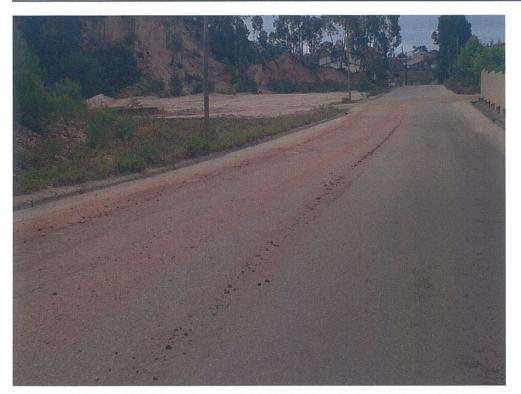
Portela do Outeiro - Acumulação de areias na via oriundos das zonas de exploração.
